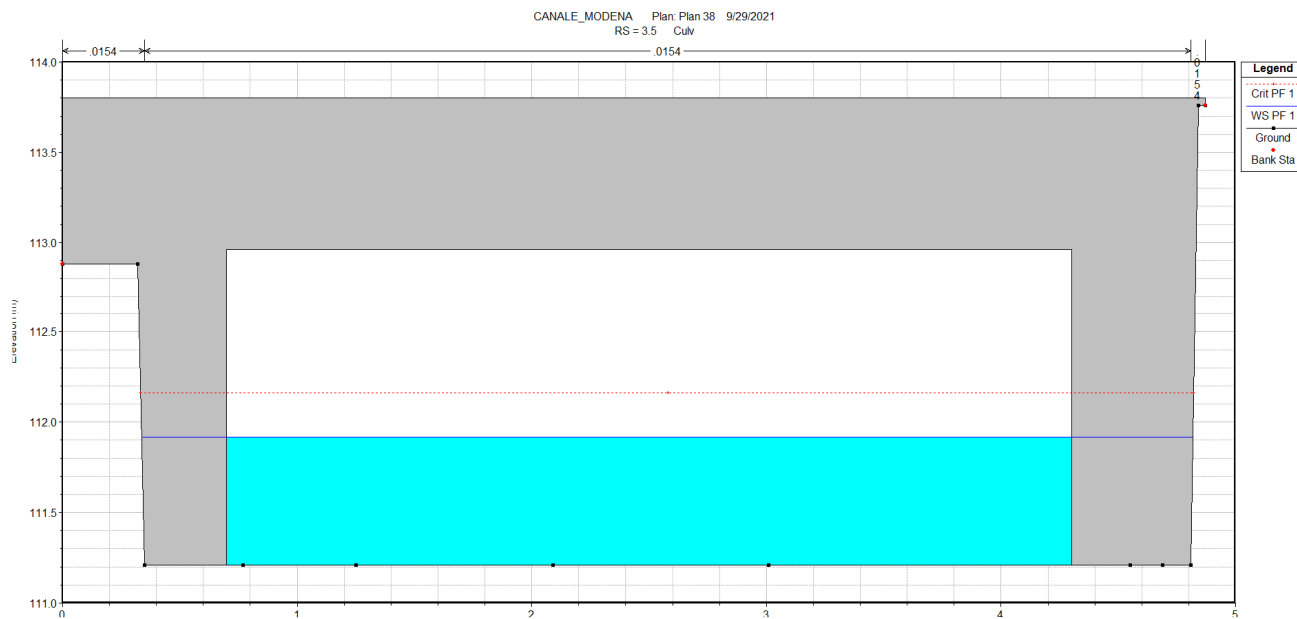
SEZIONE – USCITA CULVERT DI VALLE – 360X175
